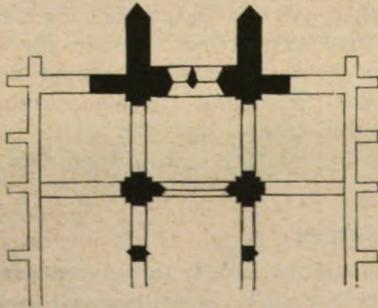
Grundriss des Thurmes nach Mauch.
